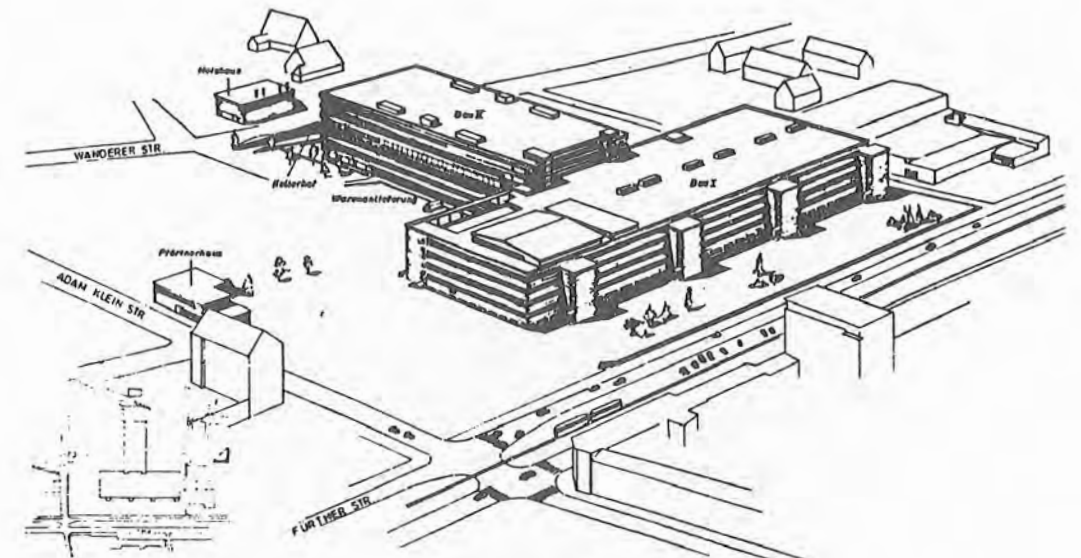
Im 2. Bauabschnitt wurde neben dem Pflanzhaus der Erweiterungsbau II als Flügelbau mit 5 Obergeschossen, also einer Höhe knapp unter der Hochhausgrenze, gebaut. Gleichzeitig entstand das Heizhaus
